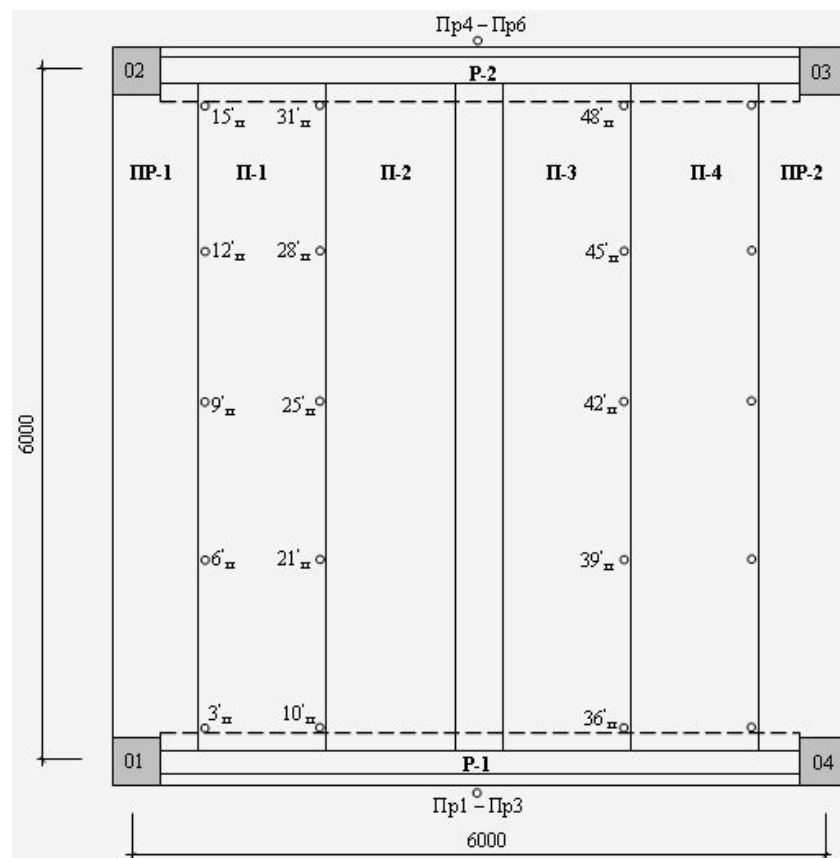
Схема расстановки приборов по верху фрагмента перекрытия
